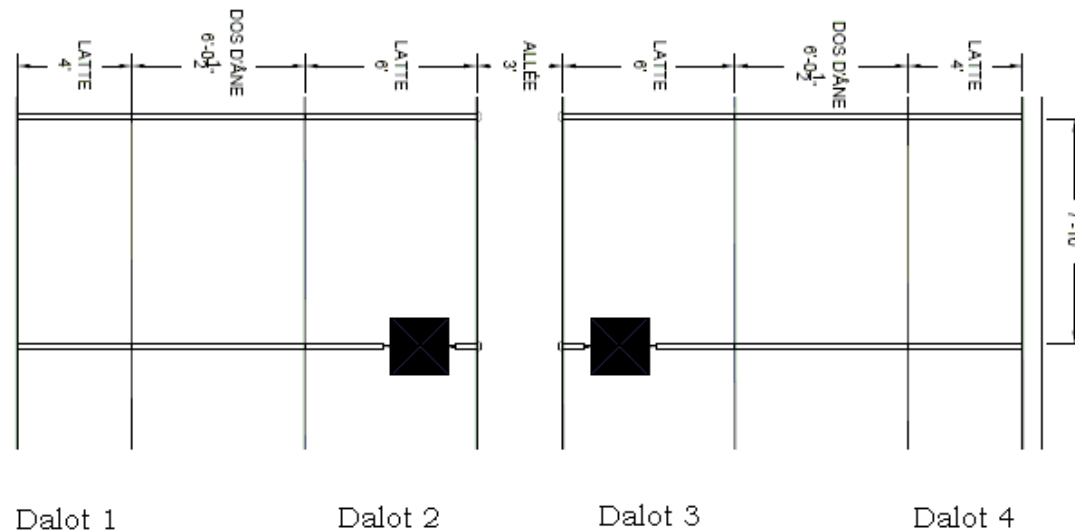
Vue schématique et en plan d'une coupe latérale de Engraissement St-Louis
